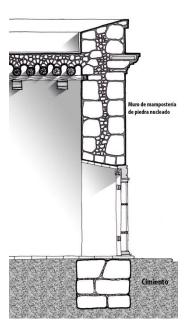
Detalle de muro de mampostería, (fuente: SEDUMA)
